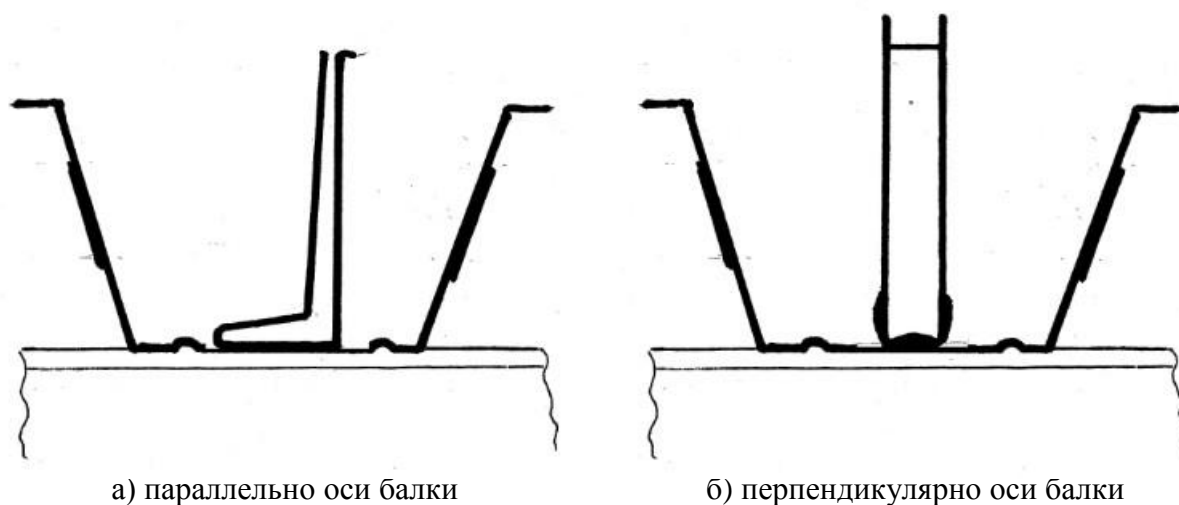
Размещение анкерных упоров HILTI на железобетонном монолитном перекрытии (вариант)
